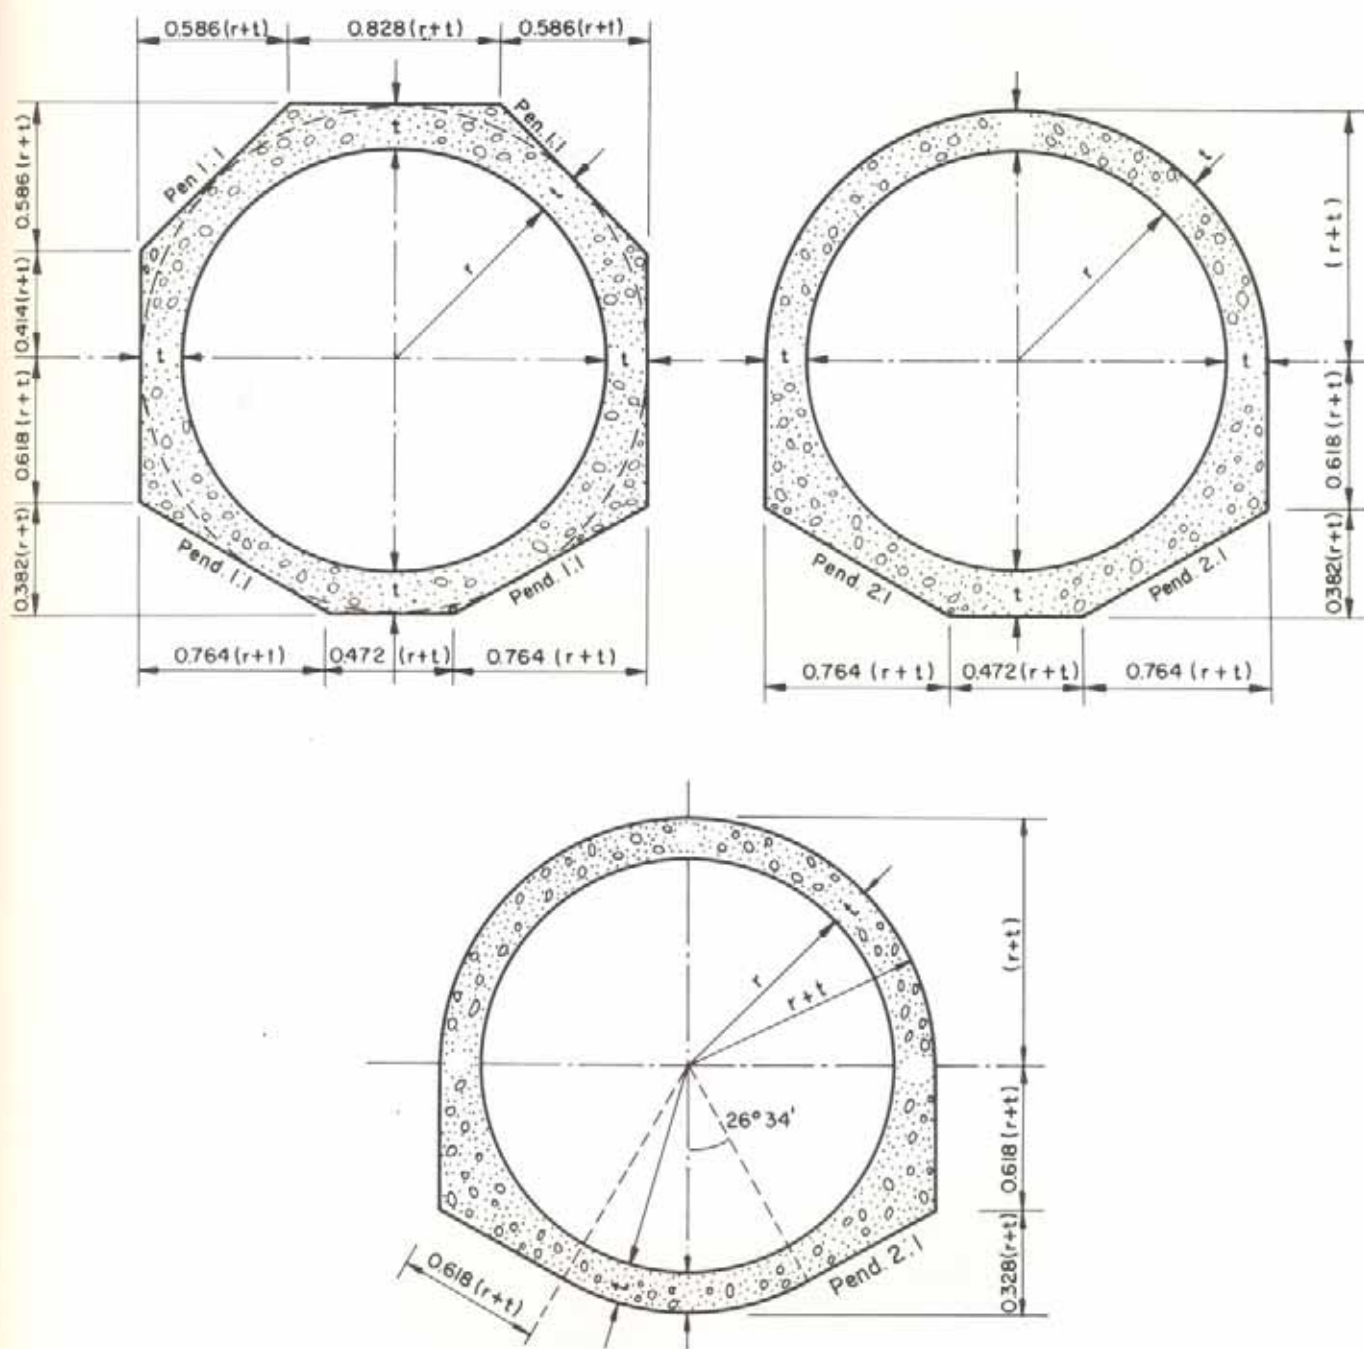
Tipos especiales de alcantarillas circulares.
